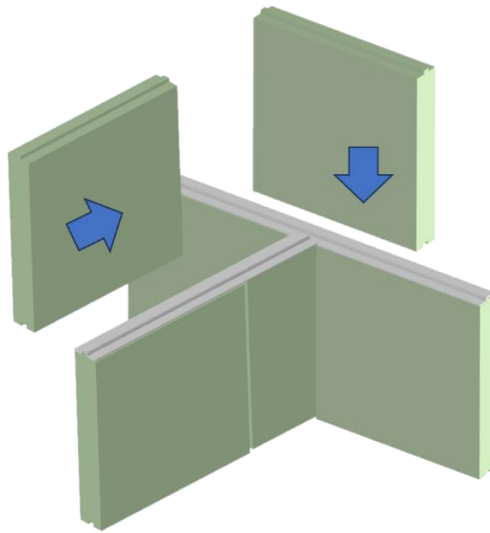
Монтаж плит при пересечении перегородок друг с другом
